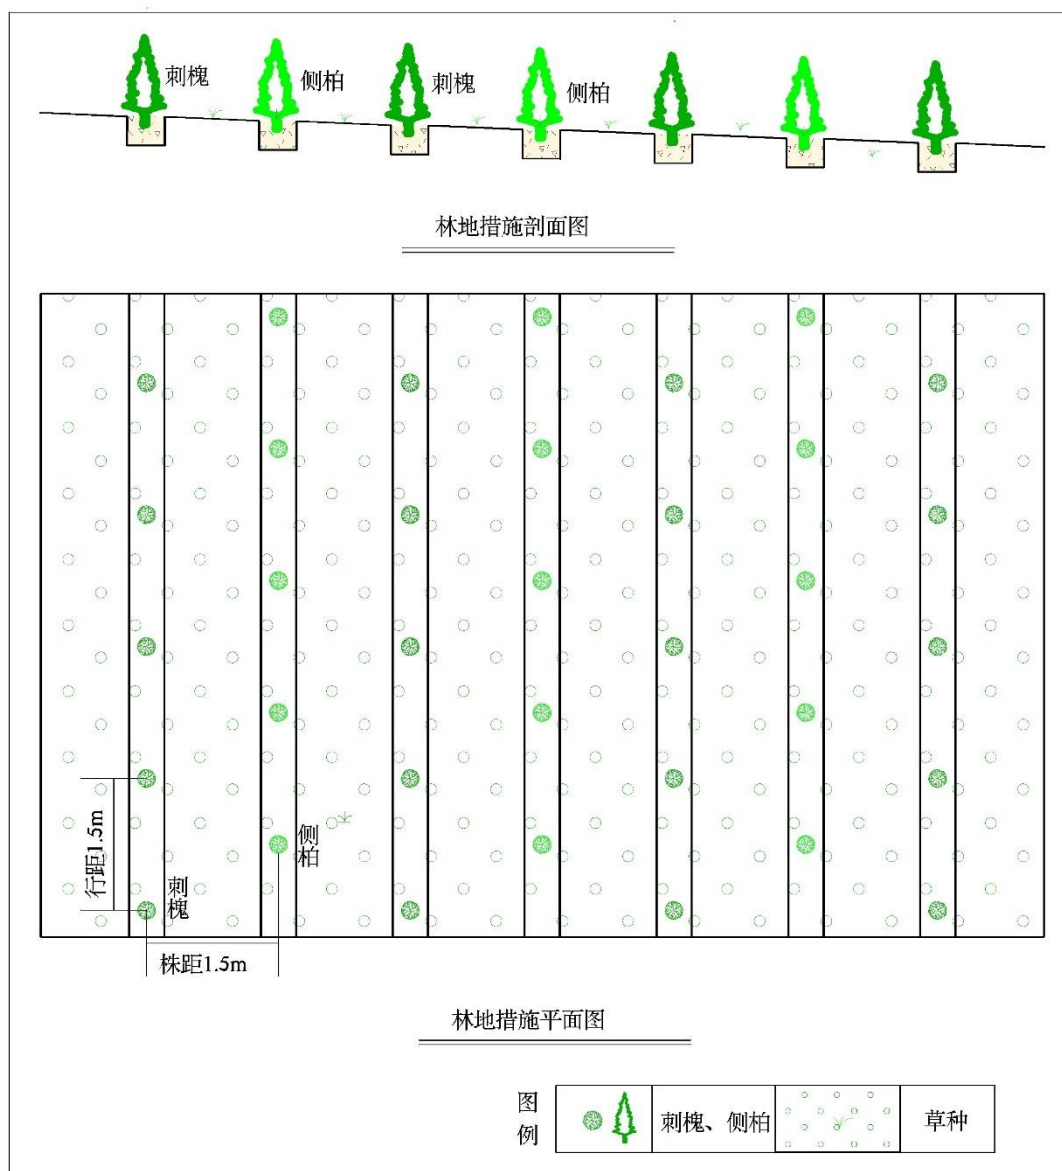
K1 露天采场平台乔木林地复垦单元工程设计剖面图、平面图
